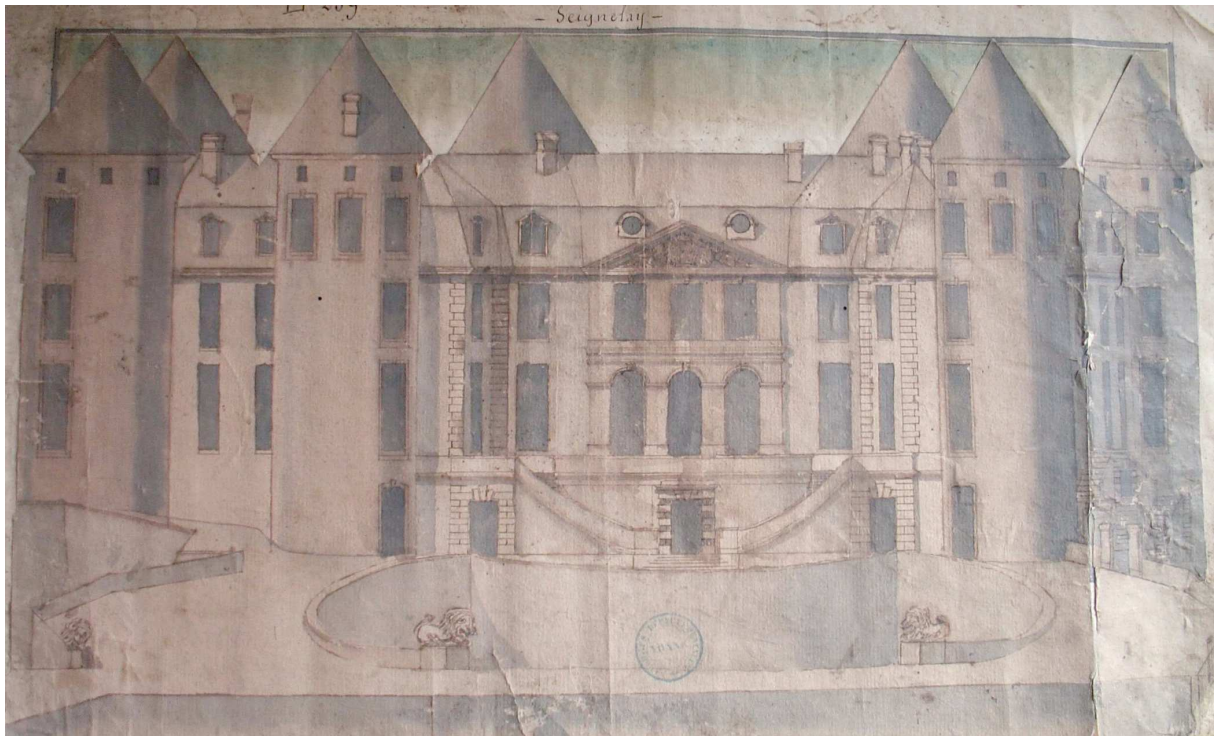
Plan de la façade du château de Seignelay au XVIIIe s. (ADY, E239)
